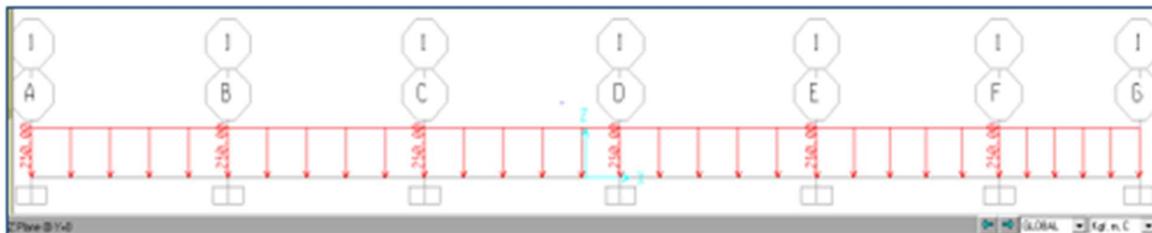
SAP2000, Carga Viva (Kg/m2) Losa Aligerada.
